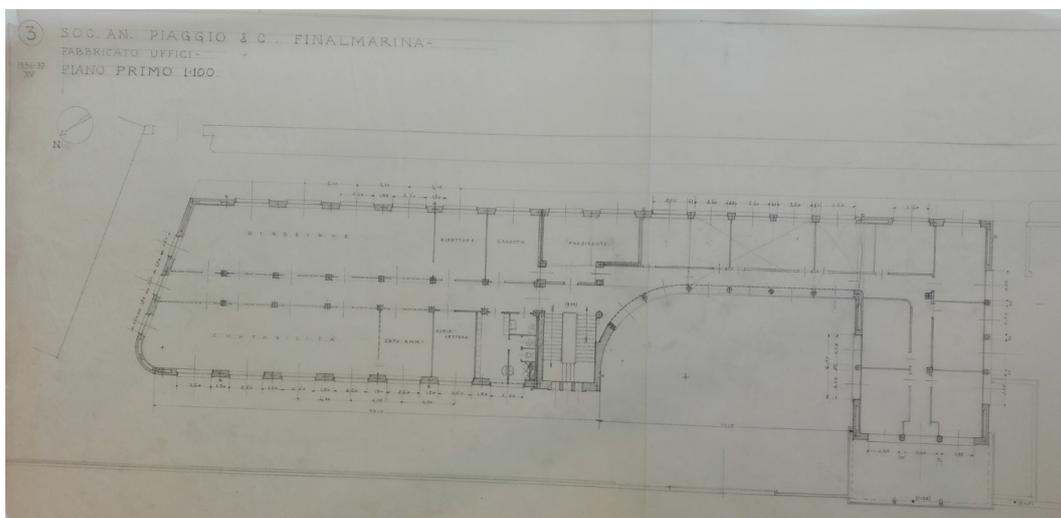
Pianta piano primo della Palazzina Uffici (Fonte: Archivio di Stato di Torino, Fondo Momo)
